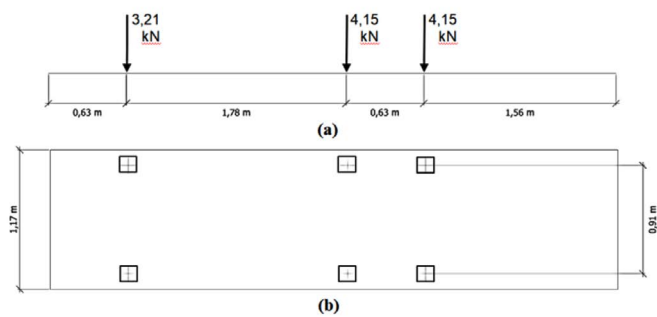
Esquema do veículo e dimensões do modelo reduzido: (a) em elevação, (b) em planta. Fonte: Elaborado pelos autores.
